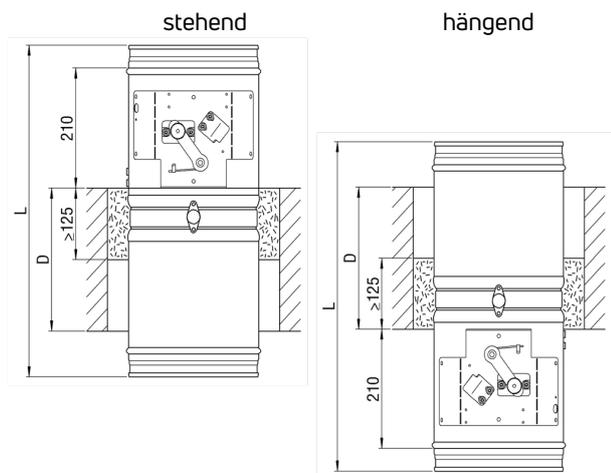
Einbaulagen in massiven Decken – (Nasseinbau)
